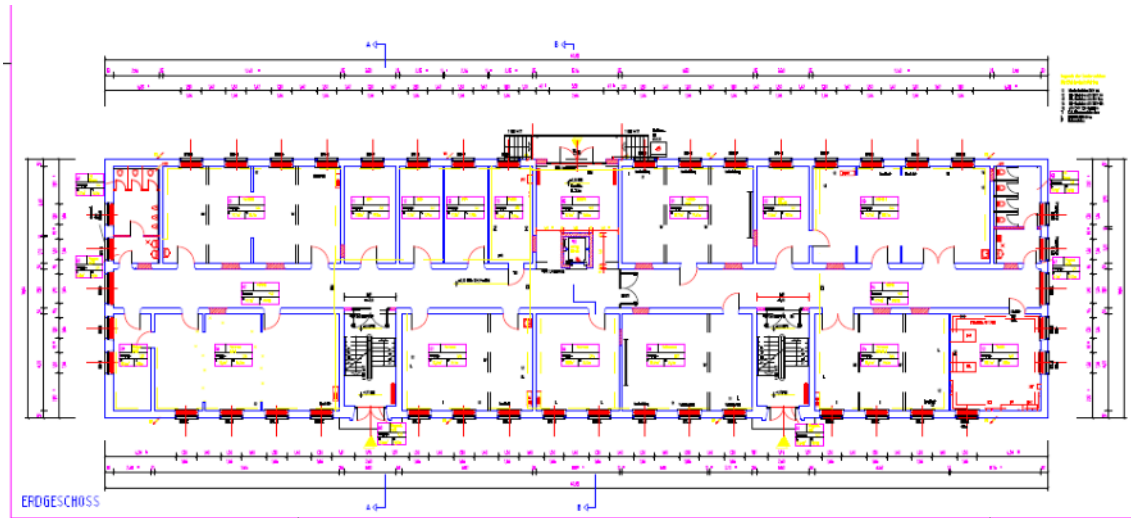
Grundrissplan Erdgeschoss, Gebäude FC
